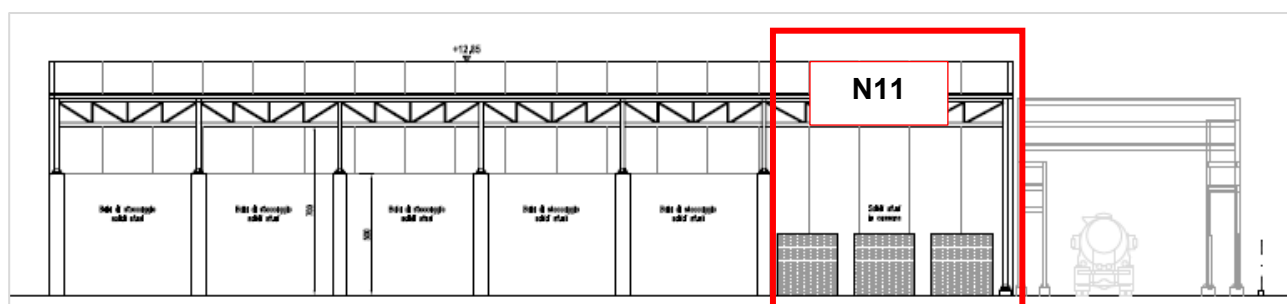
Prospetto EST (Stralcio elaborato CO 05 RA VA 01 D1 PL 69.00 - N3-N11 PROSPETTI E SEZIONI)
